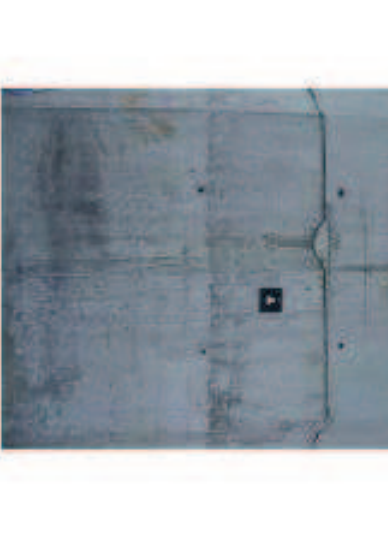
Amadura vista por la base de la reparación en la pile 13
